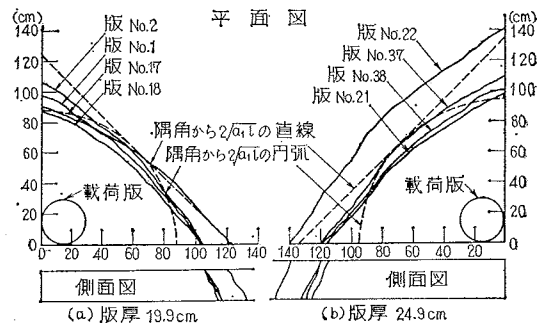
コンクリート版膨張目地隅角におけるひびわれ発生位置
